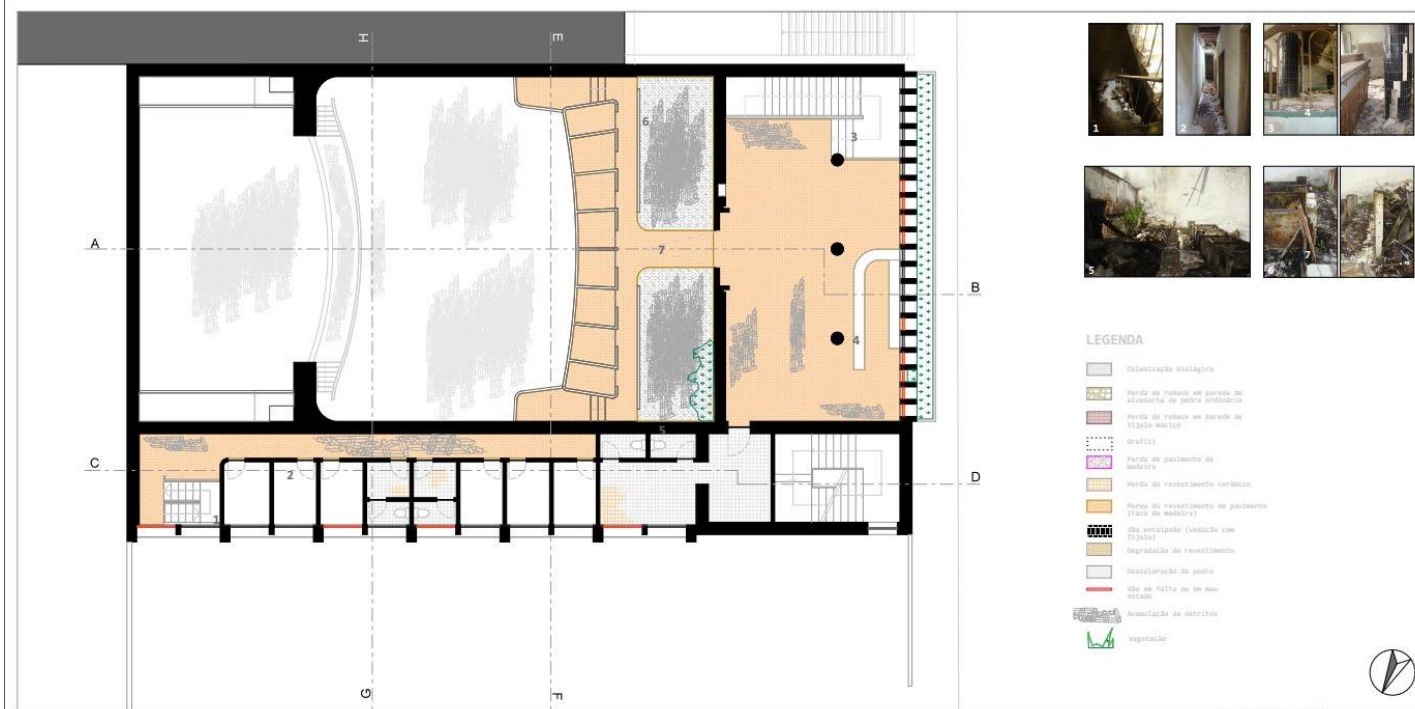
Estado Conservação Planta Piso 1, Pedro Santos 2017
